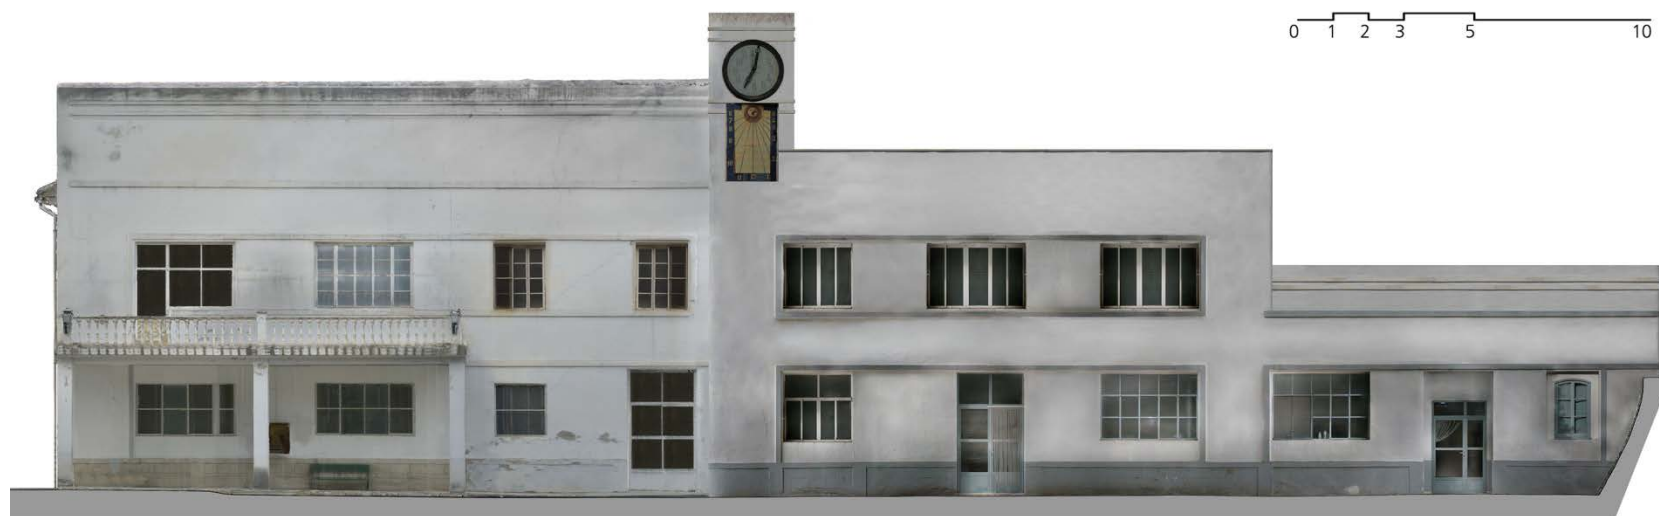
Fotoplanos fachadas del Pabellón Central y Pabellón de La Purísima. Intervención década 1940. Orientación Sur. Escala Gráfica.
